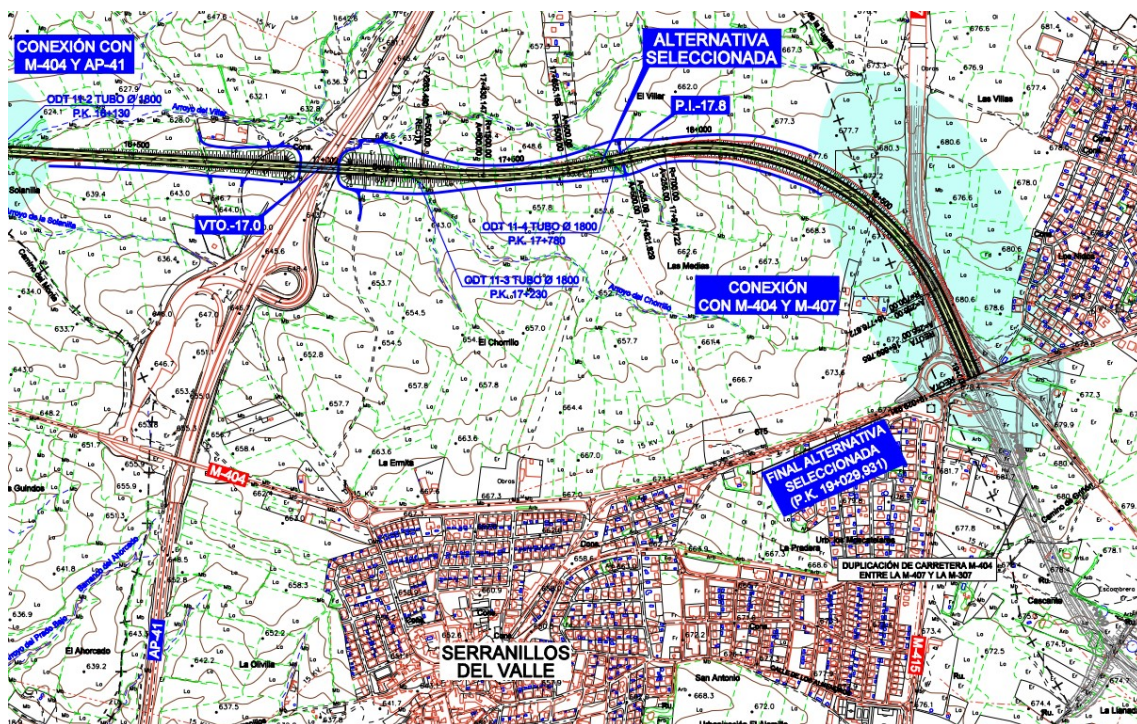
Proyecto de Construcción de la Duplicación de la M-404.
